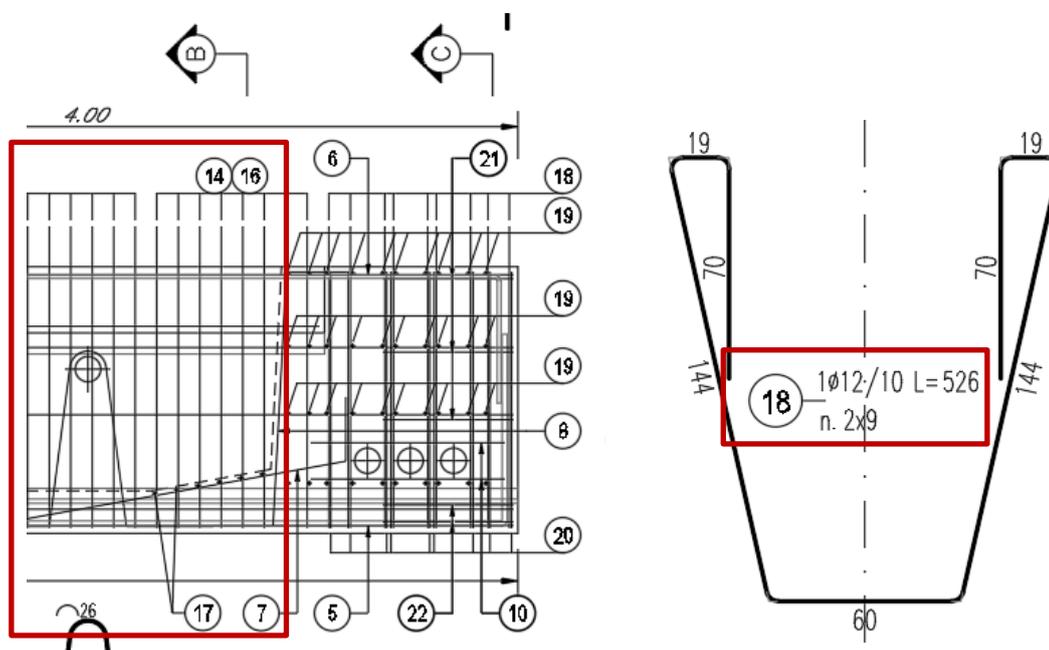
Le staffe 18 controllano il fenomeno combinato di spalling e spreading nel tratto tra appoggio e sezione
